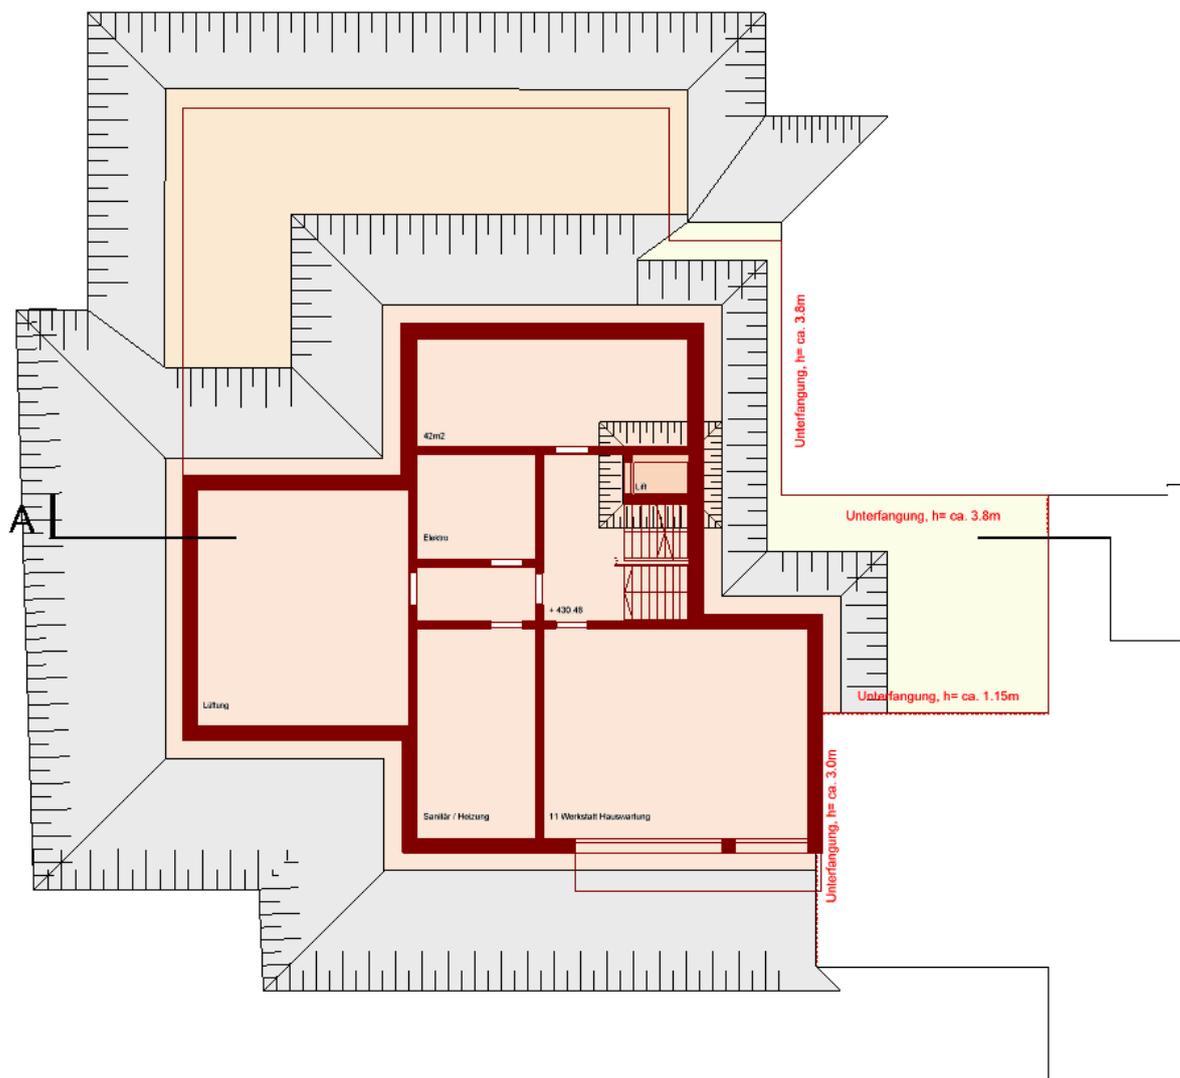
Grundriss UG03 mit Baugrube.
